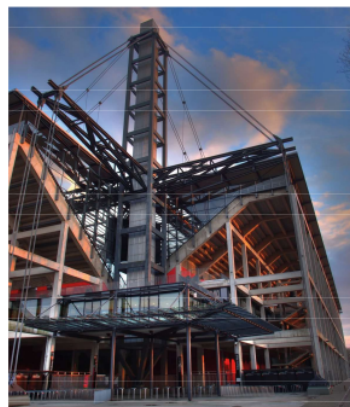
Imagen exterior de la torre y la estructura de las gradas
